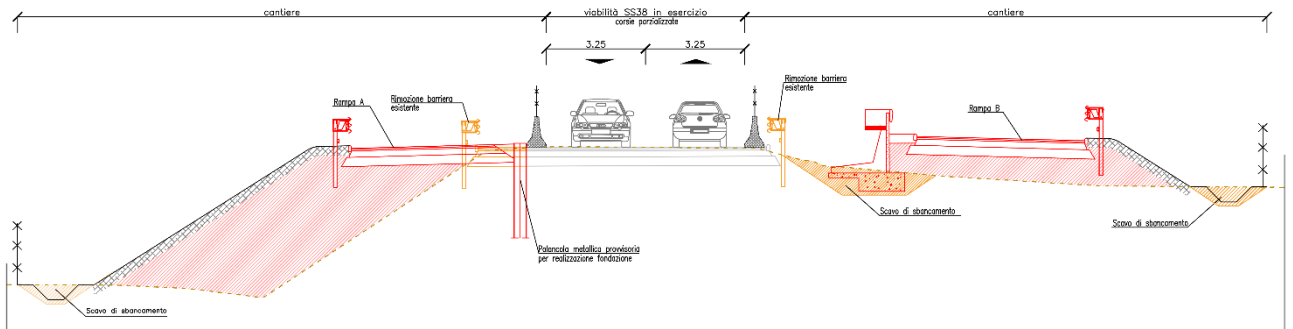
Sezione A-A Fase 3 Variante S.S. n. 38
